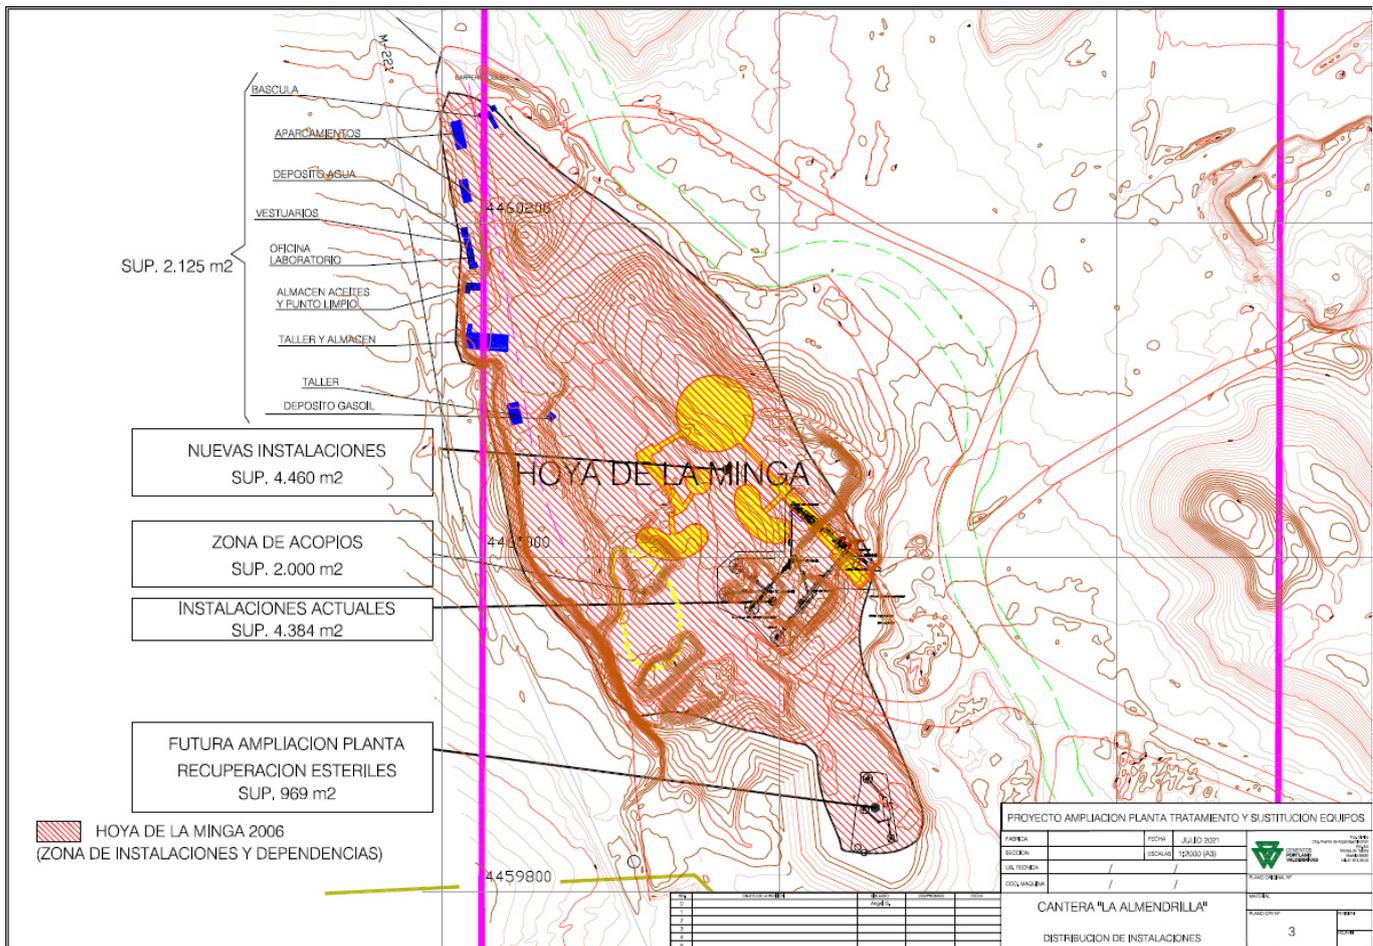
Del plano de detalle de ubicación de la planta y la superficie que ocupa.
